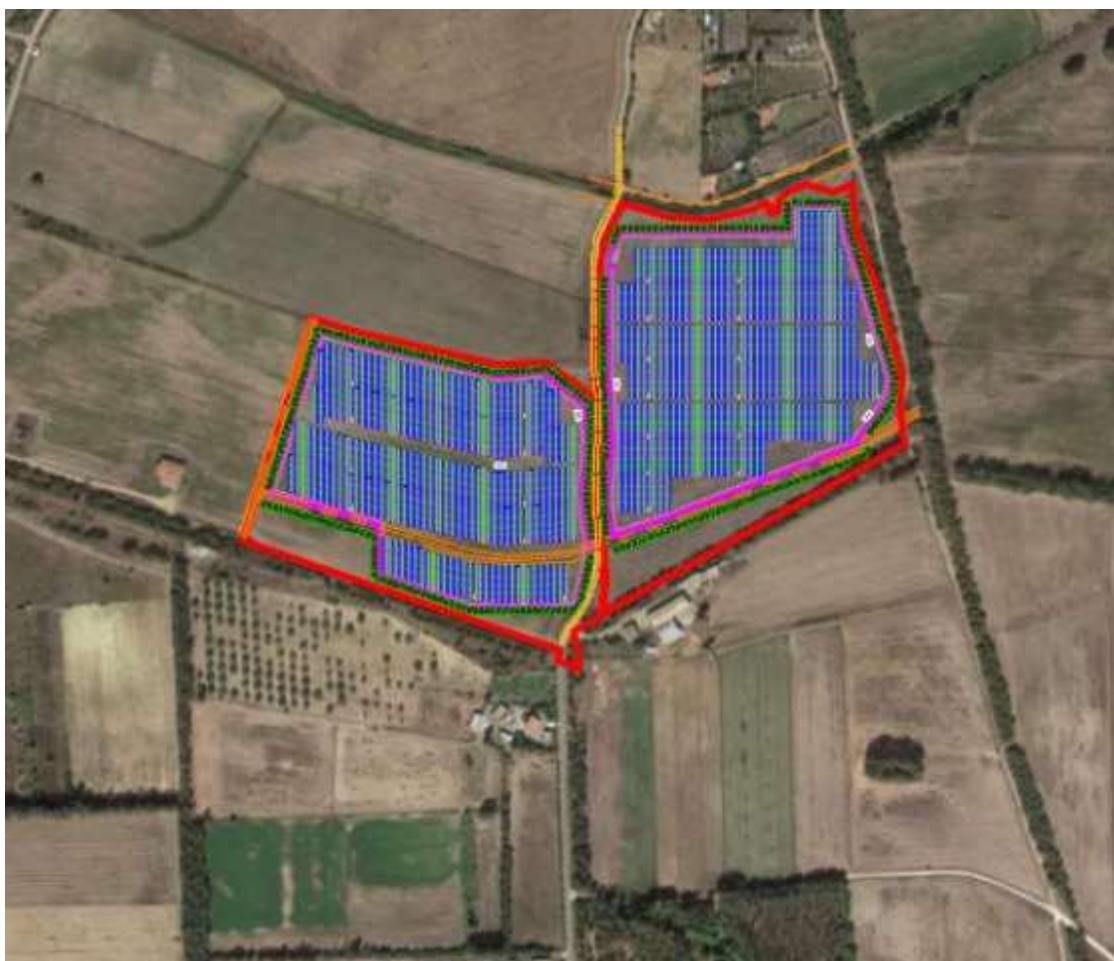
LAYOUT IMPIANTO FTV SU ORTOFOTO
